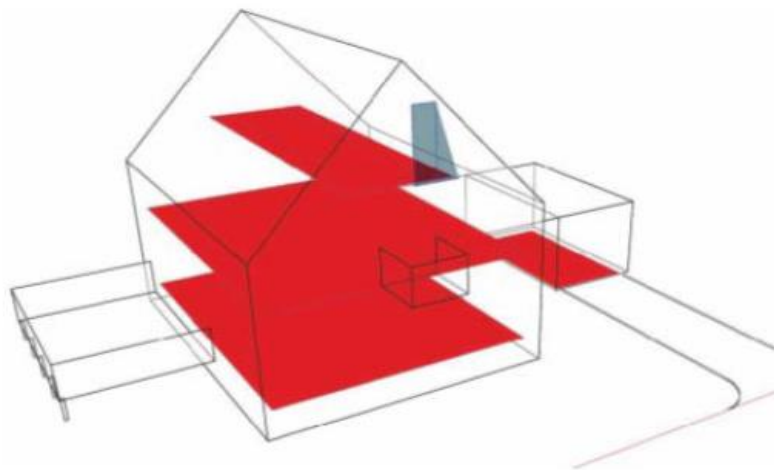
Bruksarealet for en bygning er summen av bruksarealet for alle måleverdige plan uavhengig av om planet er innredet eller tilgjengelig
